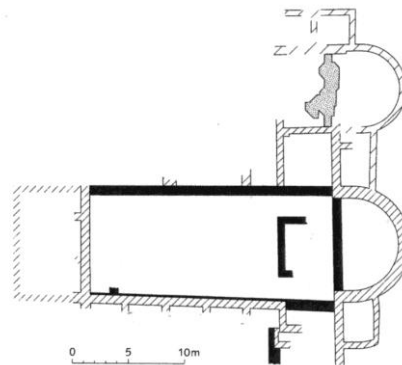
Grundriss des frühchristlichen Sakralbaus am Doss Trento.
